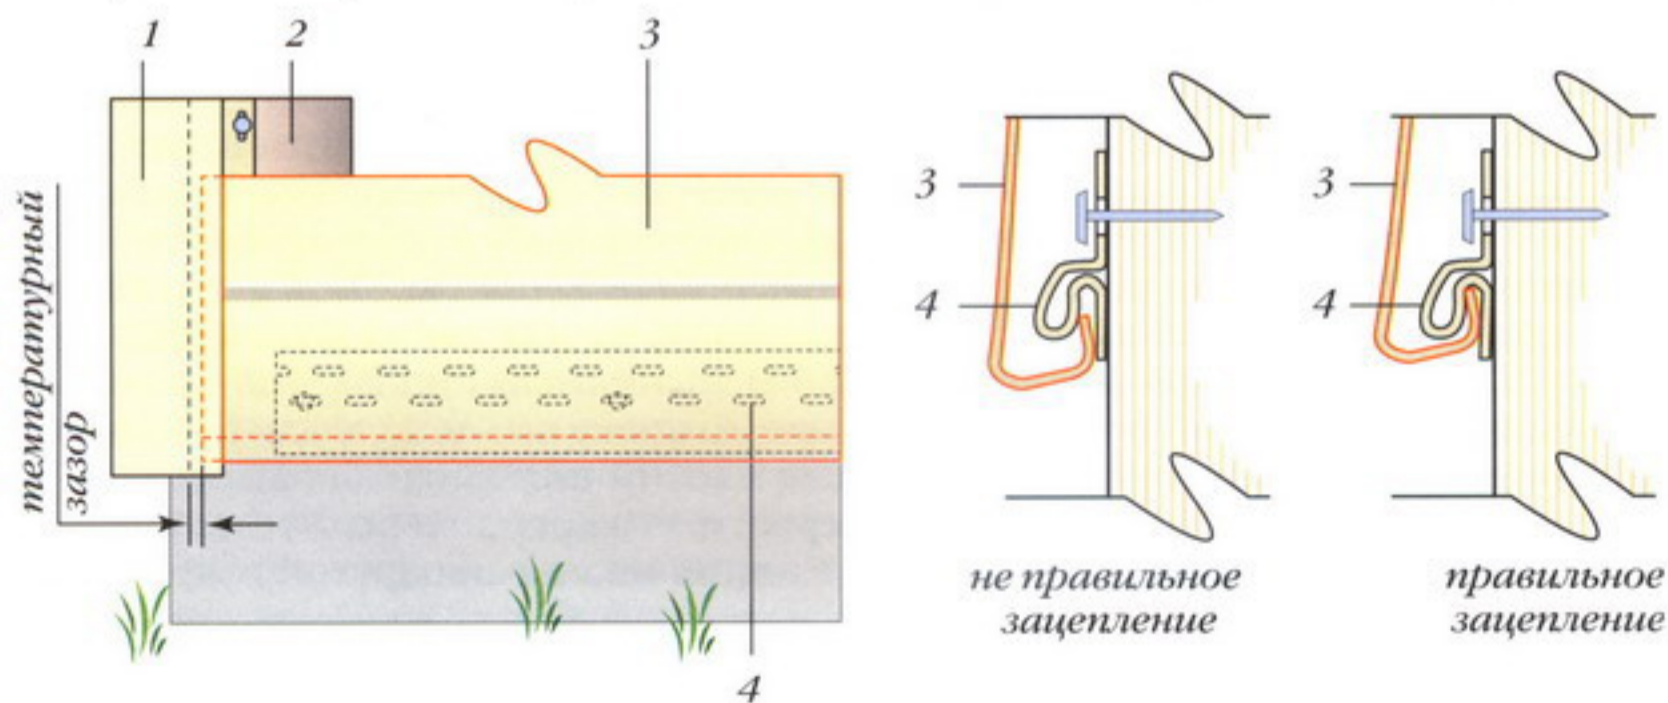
Установка первой рядовой панели сайдинга: 1 – угловой профиль; 2 – подложка (гидроизоляция) из кровельной жести; 3 – рядовая сайдинговая панель; 4 – стартовая полоса
